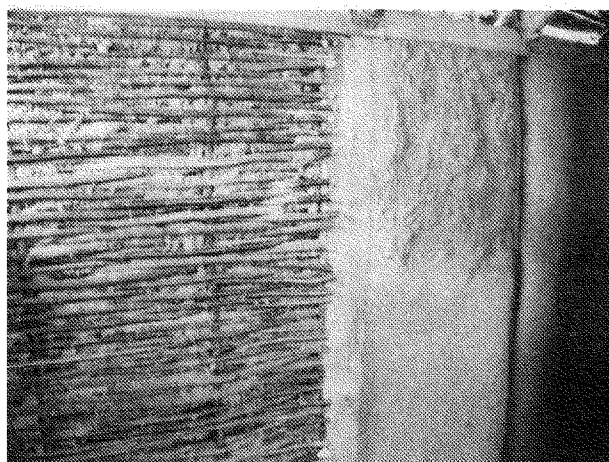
Фрагмент стены дома – плетня с обмазкой. Реконструкция из музея в Хедебю
